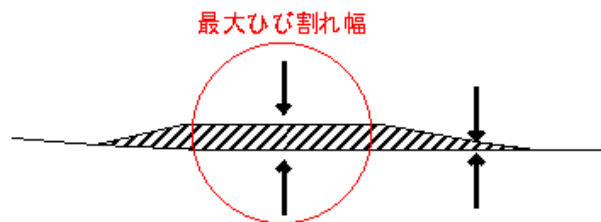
1本のひび割れにおける最大ひび割れ幅計測位置
